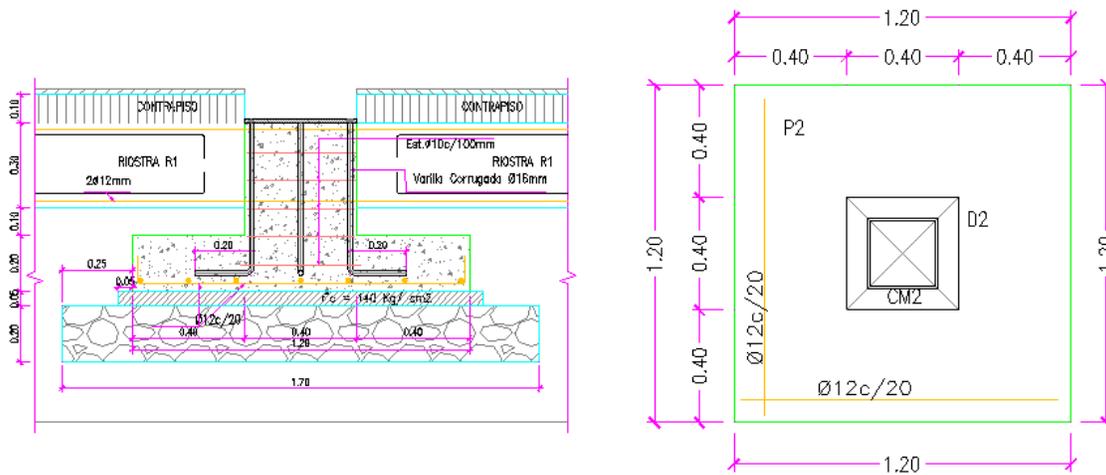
; Detalle de plinto 1,20 X 1,20 m para diseño de estructura metálica
